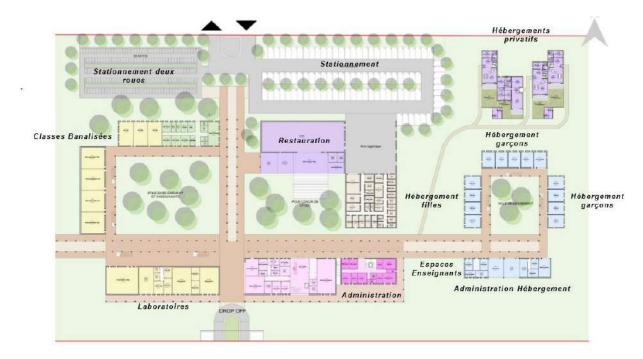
Photo B : Vue d'ensemble en plan RDC des infrastructures projetées
